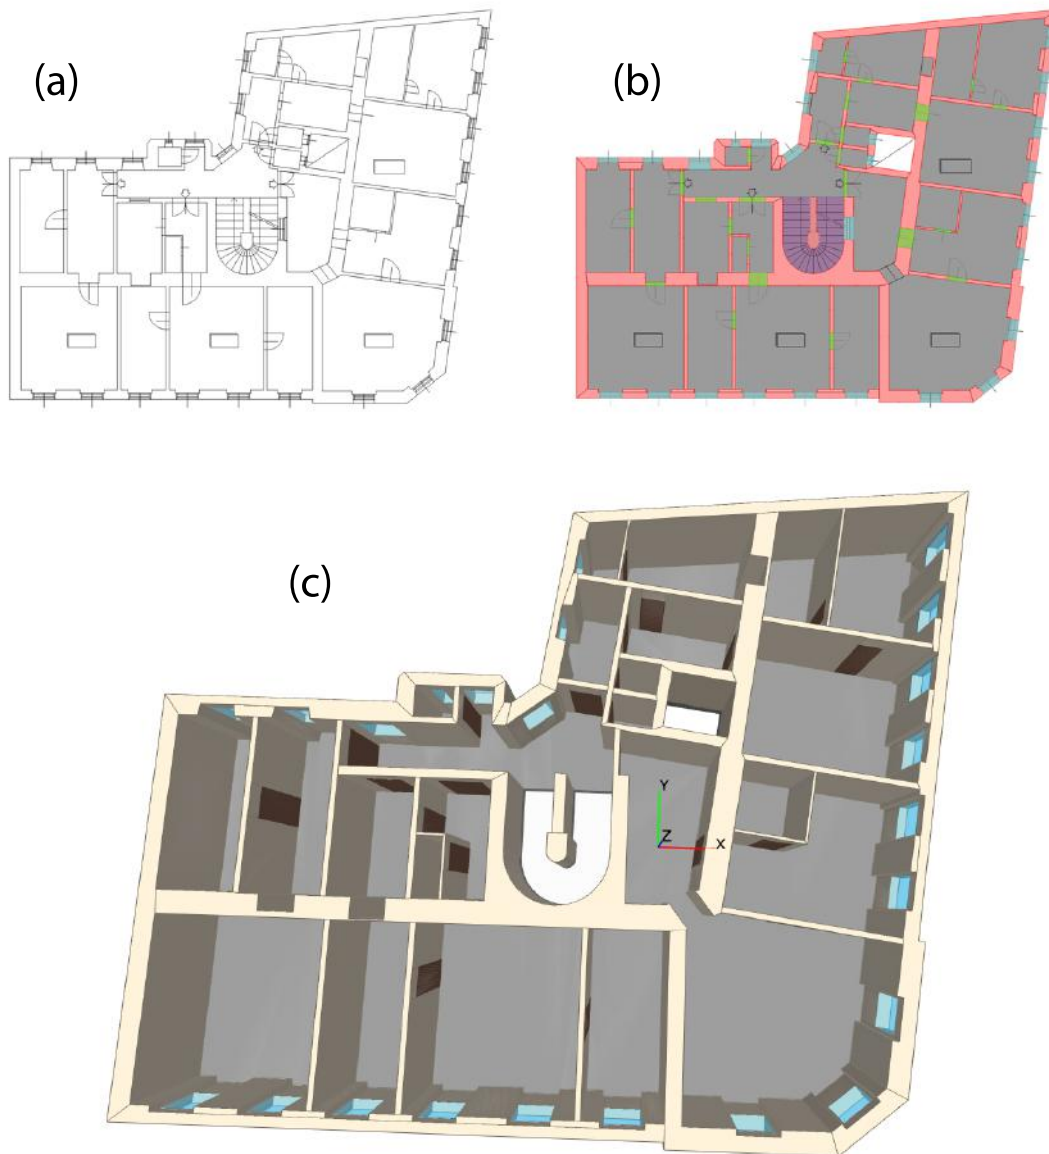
Generierung des dreidimensionalen Gebäudemodells aus einem CAD-Grundrissplan. Grafik (a): eingelesener Grundrissplan. Grafik (b): aufgefundene Gebäudebestandteile. Grafik (c): visuelle Darstellung der erzeugten IFC-Datei.
